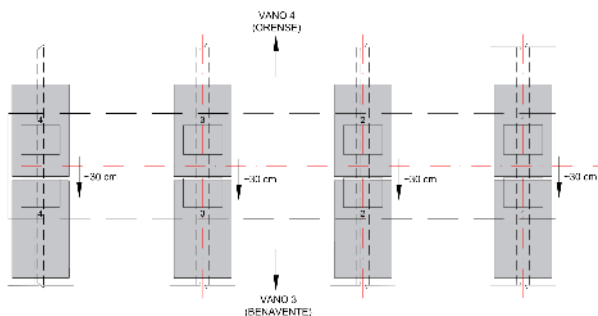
Viga reptada sobre el apoyo, sin longitud de entrega efectiva (Pila P-3, lado Benavente).
